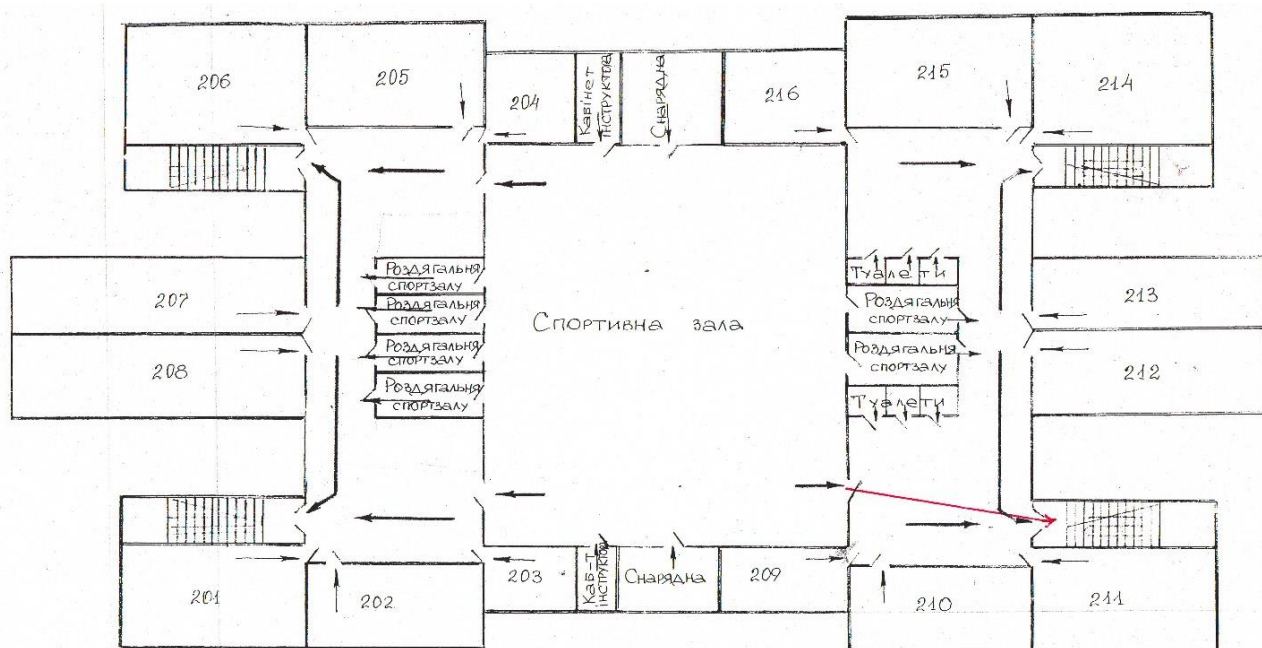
План 2-го поверху БАЛ «Гармонія»
